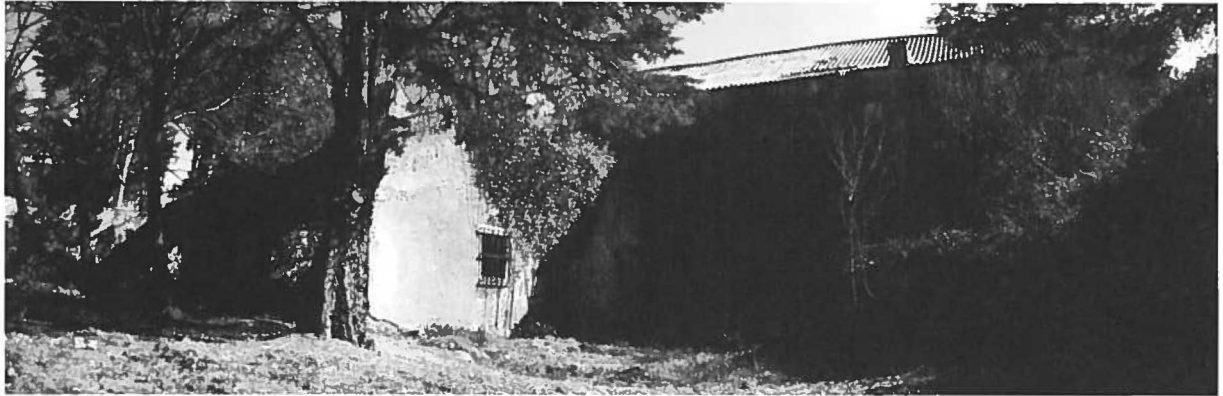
Fachada Norte. Antigas dependências adjacentes em elevado estado de degradação Fonte: Arquivo pessoal Luís Corredoura.
